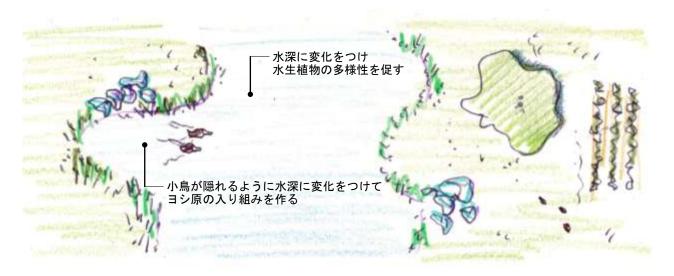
チュウヒ餌場付近計画部分平面図 S=1/200
